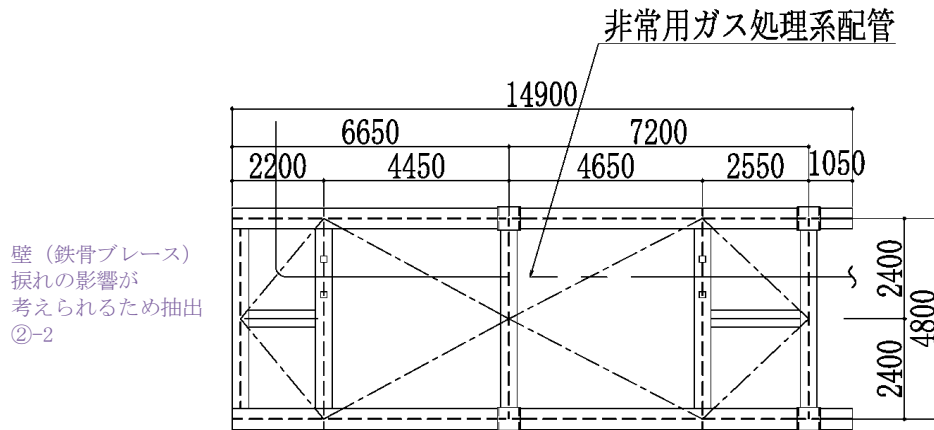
非常用ガス処理系配管支持架構の概略平面図 (EL. 20.8 m)
